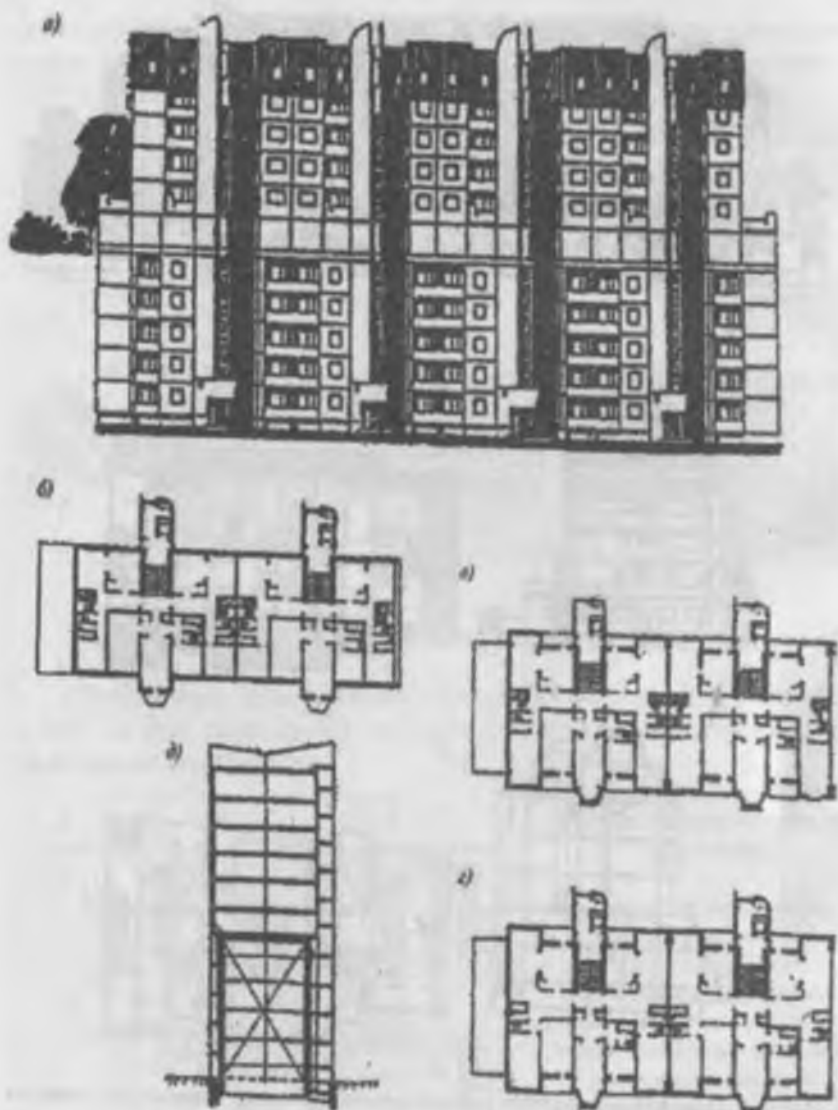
Реконструкция малоэтажных крупнопанельных зданий методом обстройки и надстройки:
